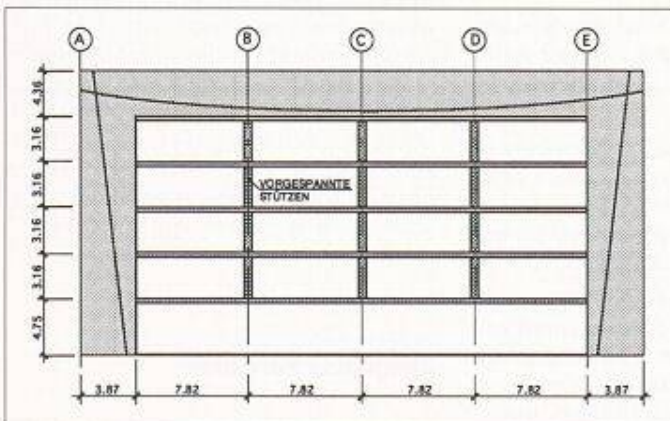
Gebäude mit allseits auskragenden Flachdecken
